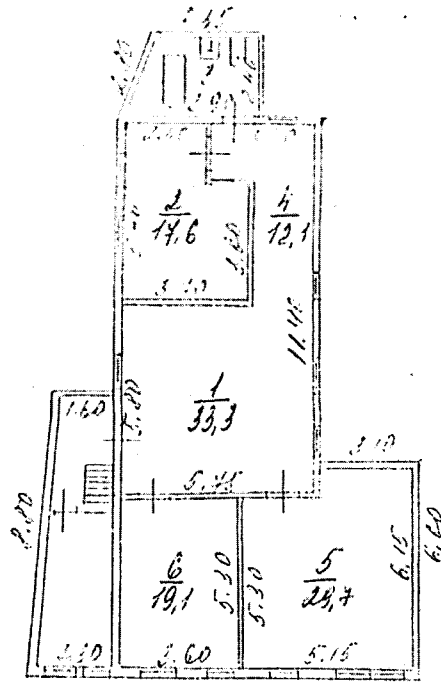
поэтажные планы жилого дома лит. А. План БТИ, 2000 г., 2002 г.
